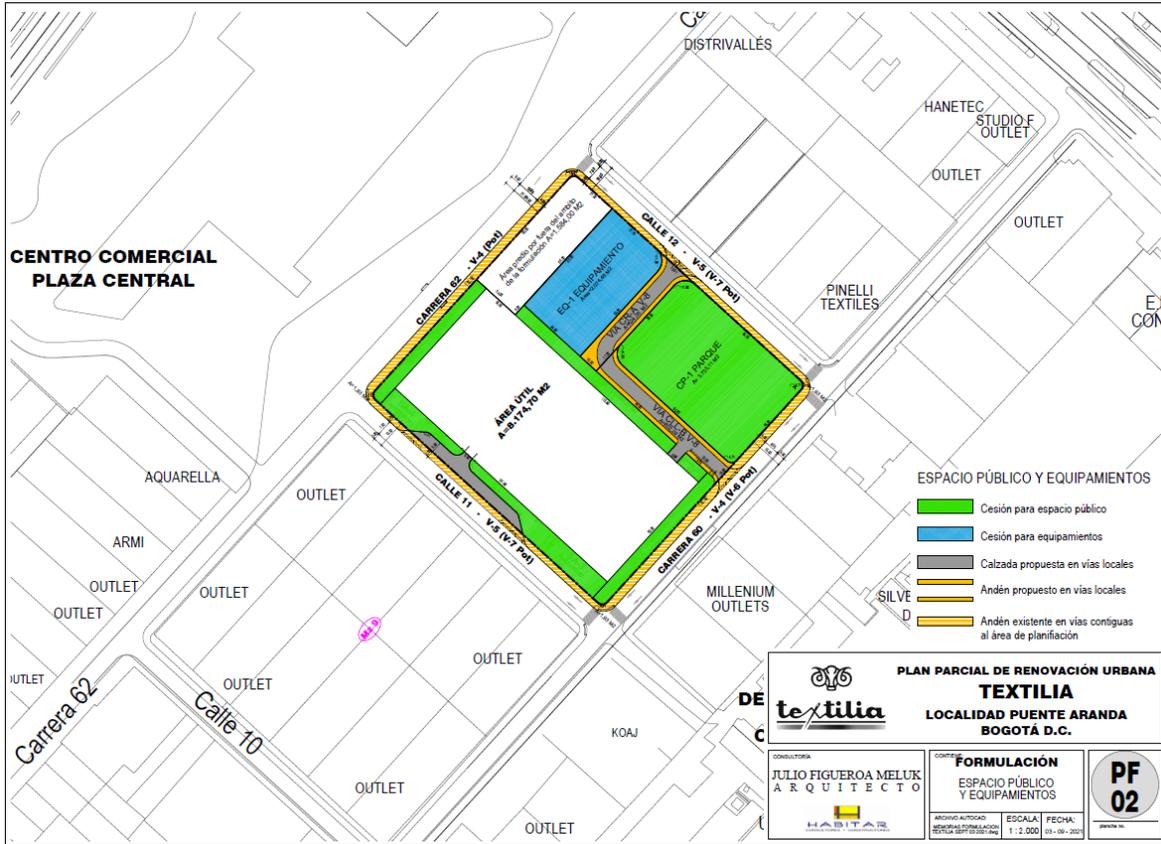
Plano PF-02. Cesiones para Parques y Equipamientos
